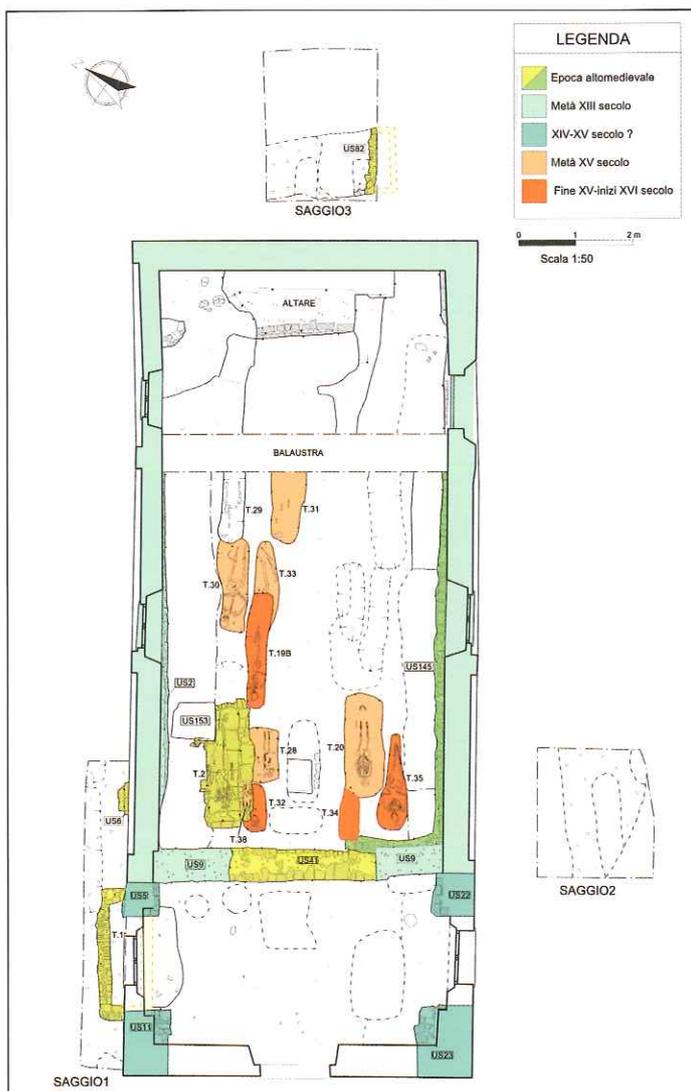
b. Planimetria di scavo con indicate le fasi dall'età altomedievale al XVI secolo.
